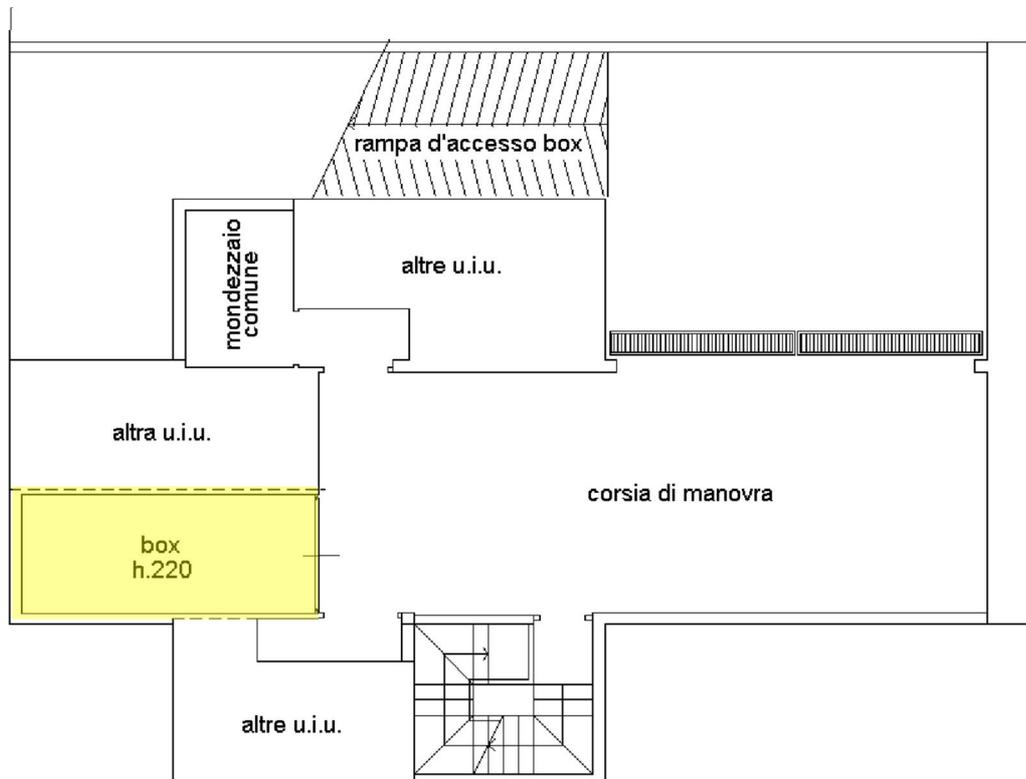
B - Planimetria del Box Auto (evidenziato in giallo) Via Privata Rieti 2 - Milano (MI).
